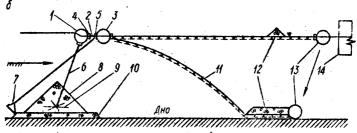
Схема безбанкетного метода перекрытия рек под защитой сетчато-хворостяного тюфяка в плане (а) и в разрезе (б): 1—буй; 2— цепь, 3— несущая плавающая труба; 8— бетонные массивы; 4, 5— скобы; 6— анкерный трос; 7, 9— якоря; 10— щебеночная подушка; 11— сетчато-хворостяной тюфяк; 12— щебень; 13— грузила-поплавки; 14— грейферный кран; 15— груженая баржа; 16— плотина; 17— пульповоды; 18— тросы; 19— буксир.
